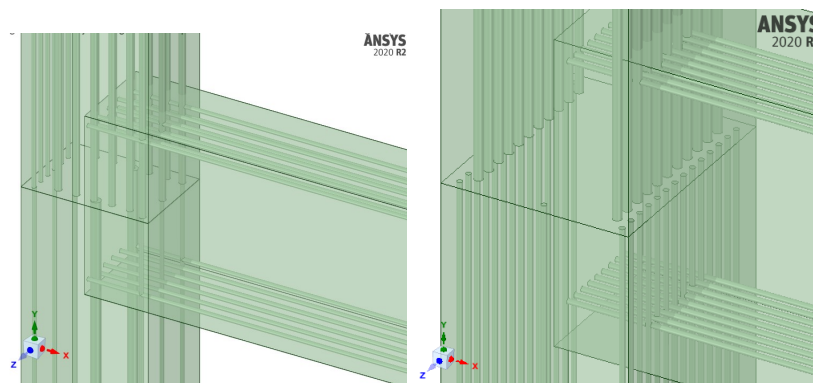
(Izq) *Detallado de refuerzo para una conexión viga-columna sin considerar criterios por empalmes y traslapes libres de choques*, (Der) *Detallado de refuerzo para una conexión viga columna considerando tales criterios por empalmes y traslapes libres de choques.
